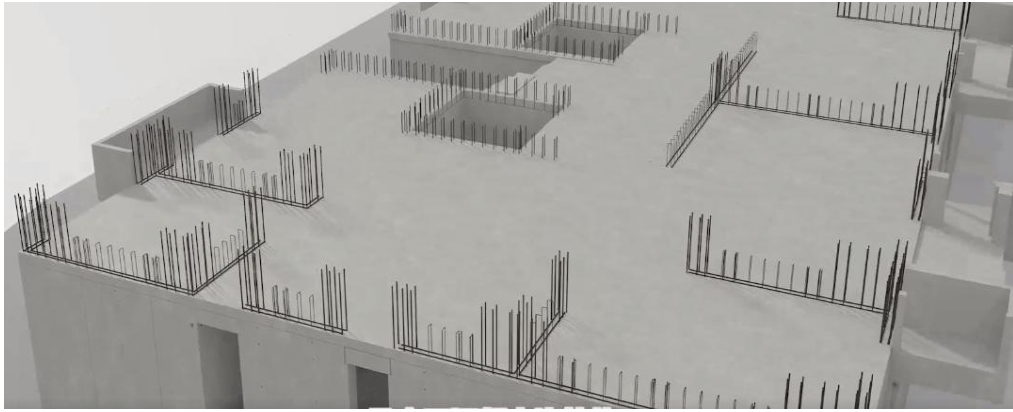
浇筑墙体空心孔及楼板混凝土、安装预制楼梯
